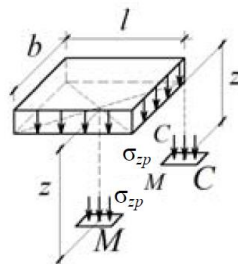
Схема к расчету напряжений σ_z для прямоугольной площади
